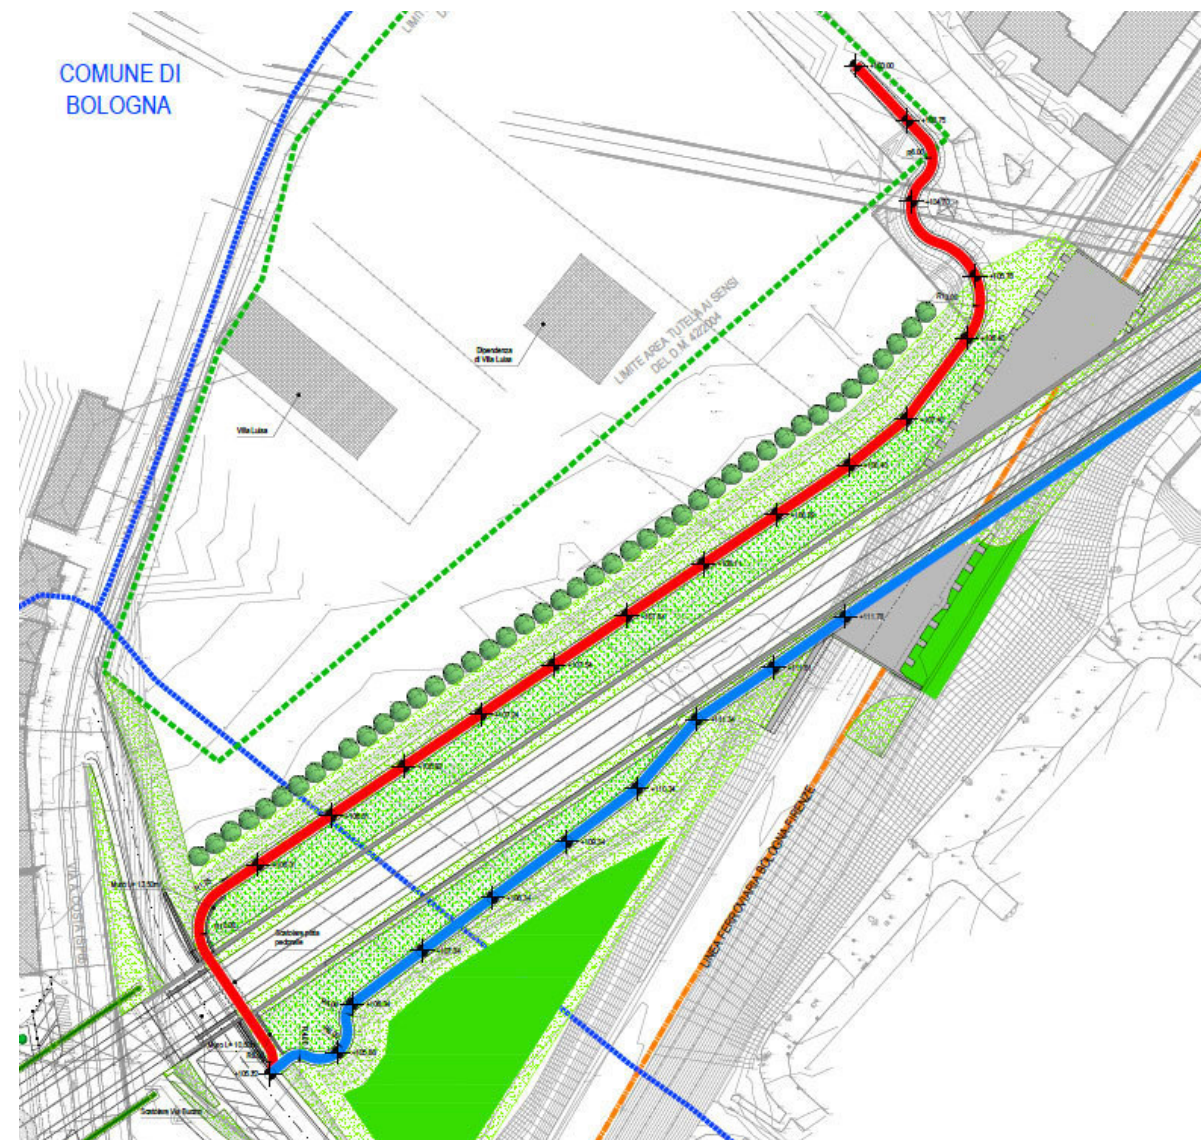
Stralcio planimetrico delle dune di mitigazione
